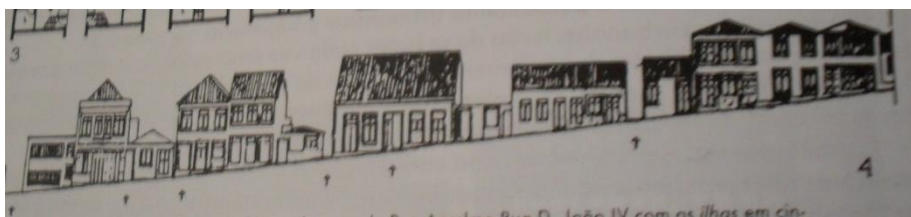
Alçado geral de uma rua. Entrada para as "ilhas", Fonte: LAMAS, José M. Ressano Garcia
